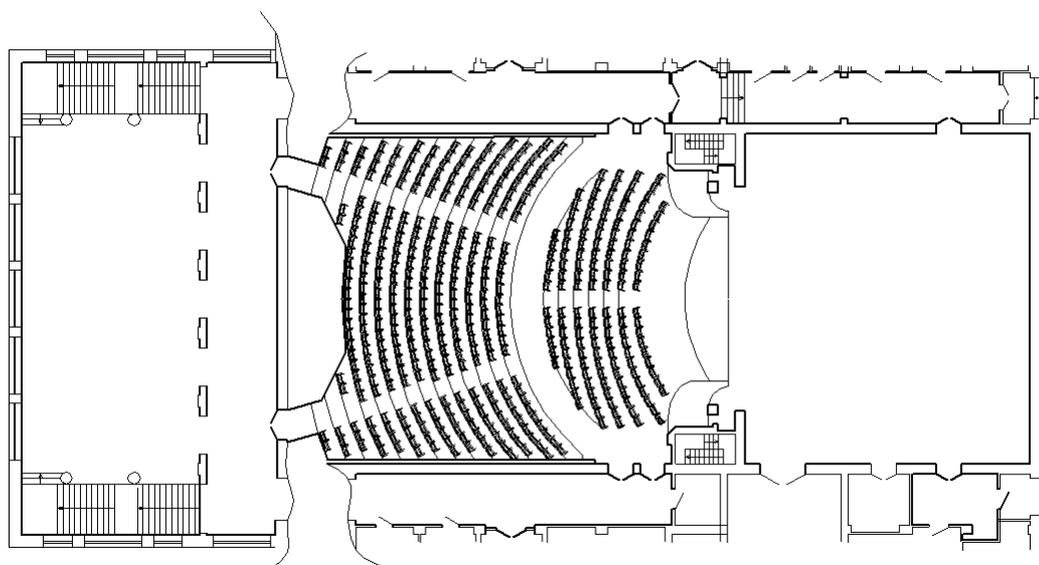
Фрагмент поэтажных планов: партер зрительного зала, сцена, кулуары и коридоры 1-го этажа, фойе 2-го этажа
